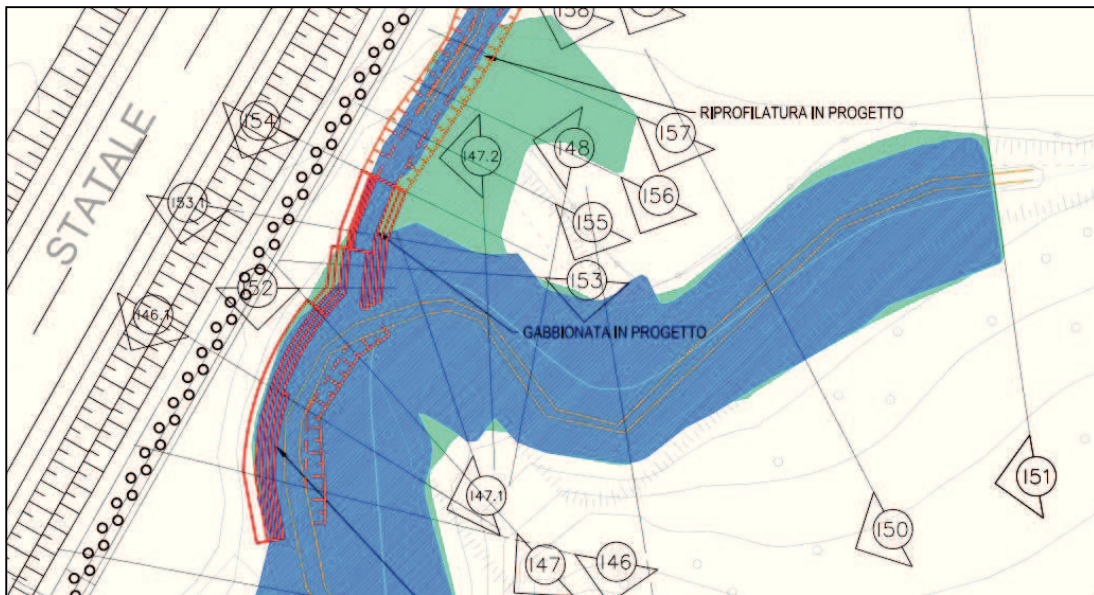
Stralcio planimetria aree esondabili torrente T1 stato di fatto e di progetto TR 100 anni – dettaglio intervento gabbionata a monte.
